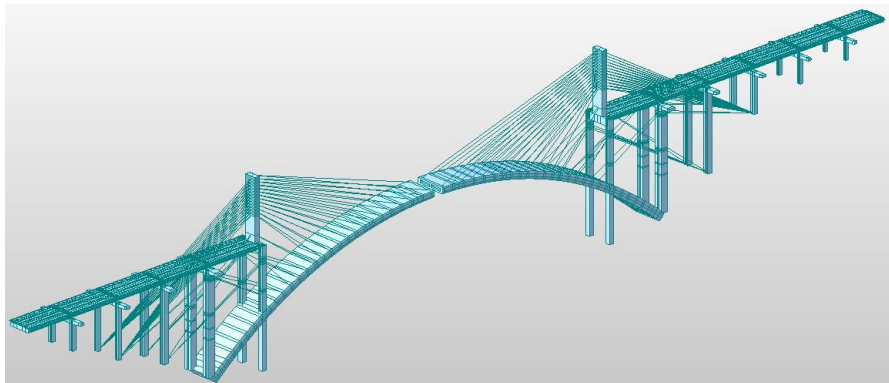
Fáze výstavby 7 – nad krajními poli je vybetonována prostřední část a je zhotoven zárodek (10 m) pro betonáž oblouku
